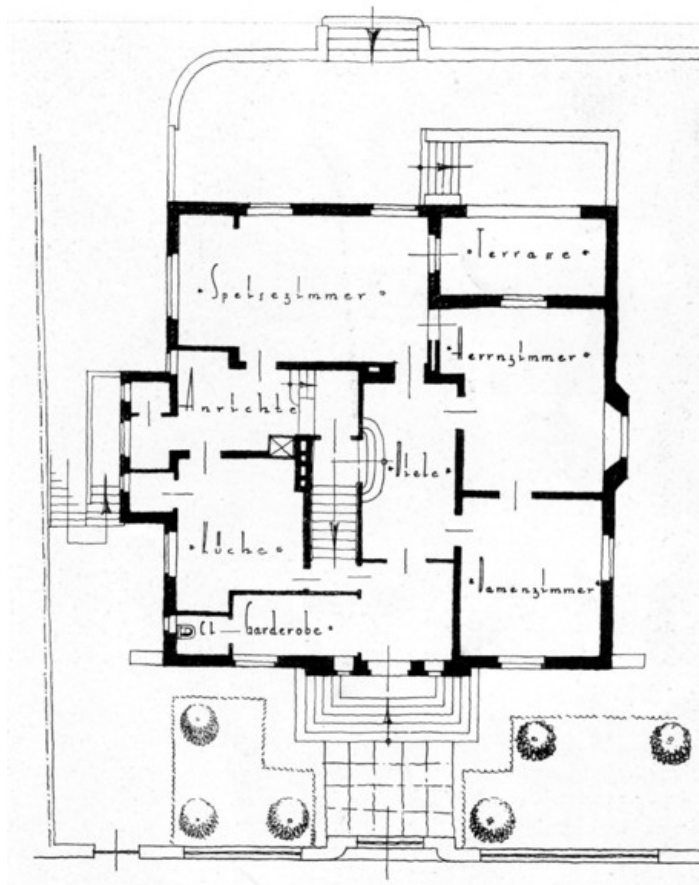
Grundriss des Wohnhauses für R. Woeste, Düsseldorf/ Grunerstraße 133 – Arch.: Walter Furthmann
